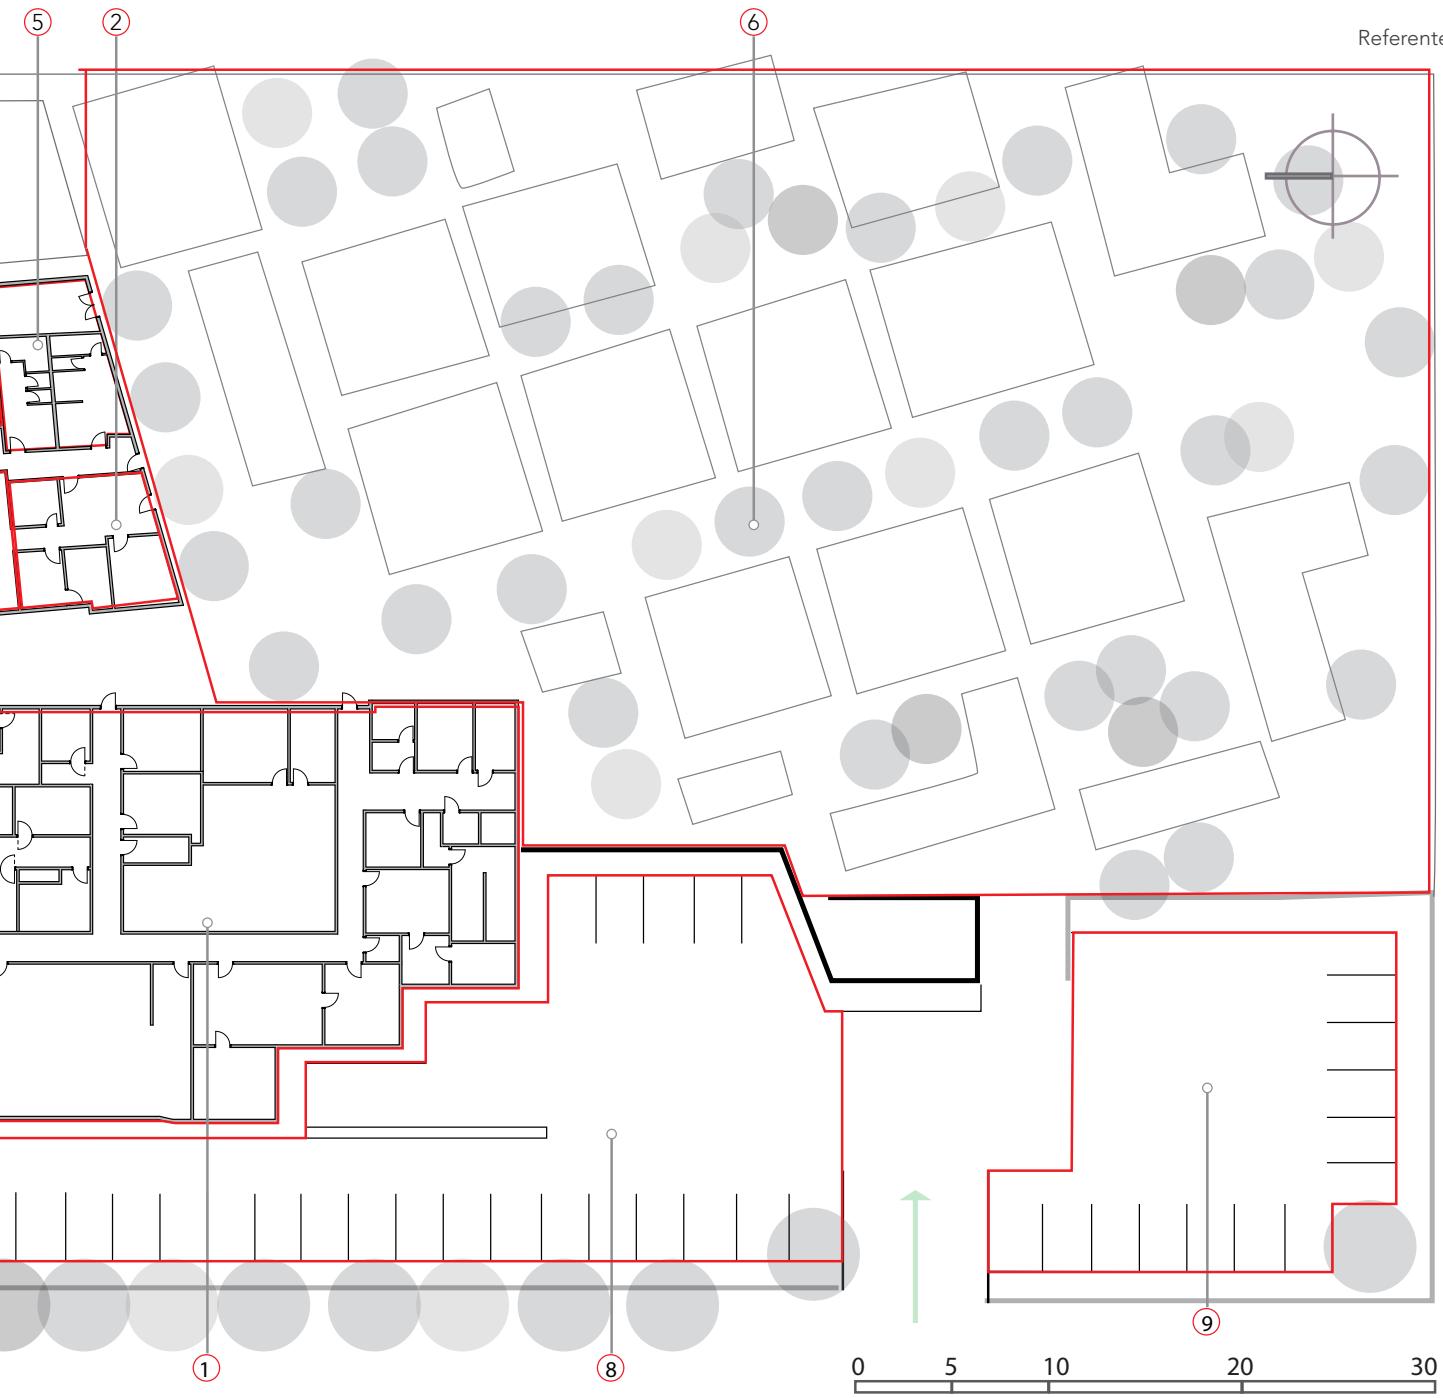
Zonificación planta proyecto del sur de Los Ángeles.
